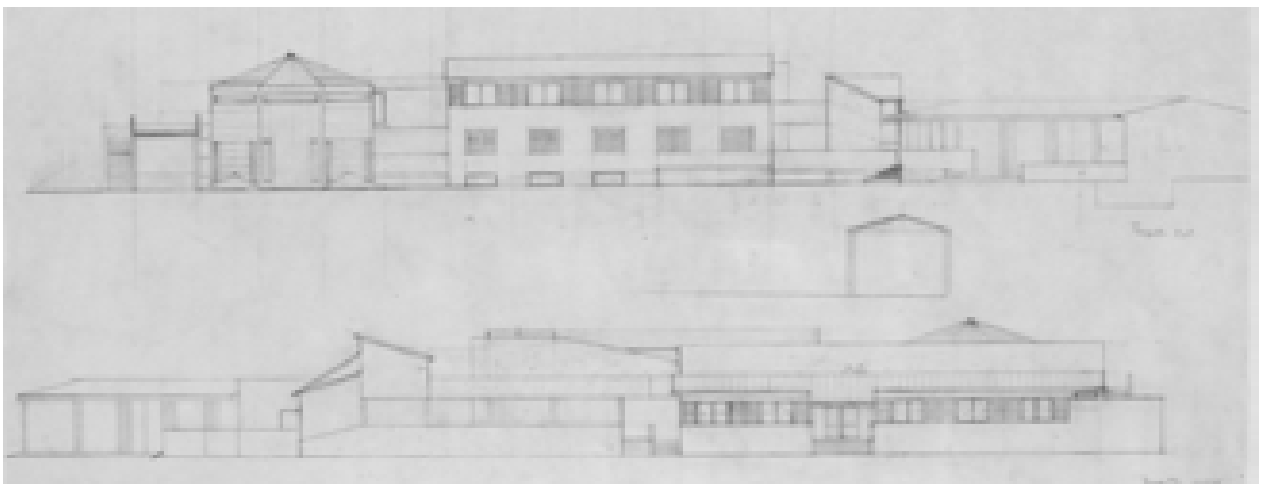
Prospetti Est-Ovest, stato futuro – 13/07/1989 (AABS-64_478)
